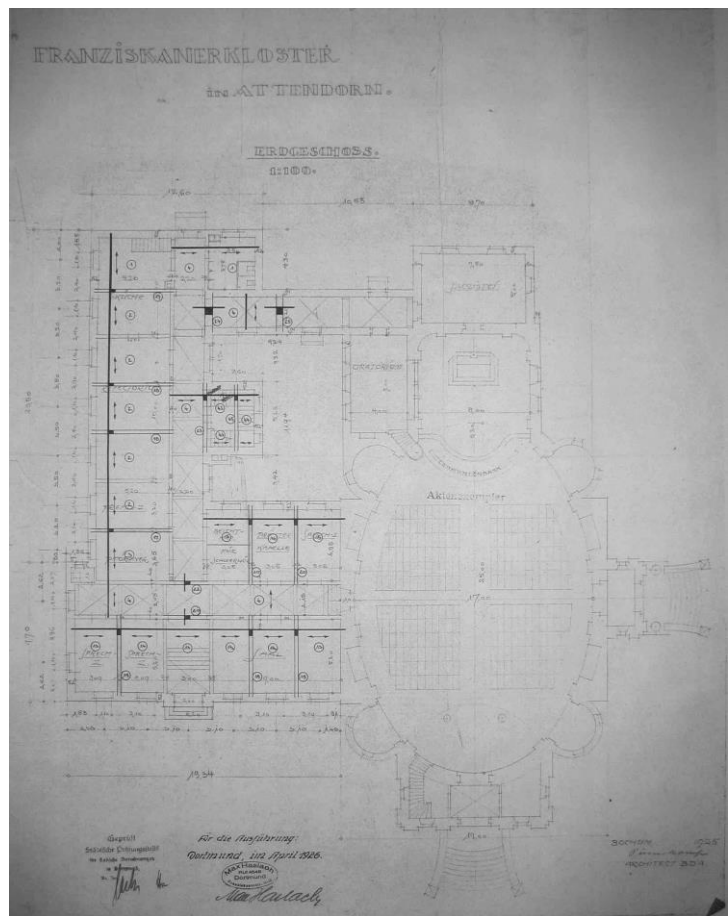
Grundriss Erdgeschoss, 31.12.1925
